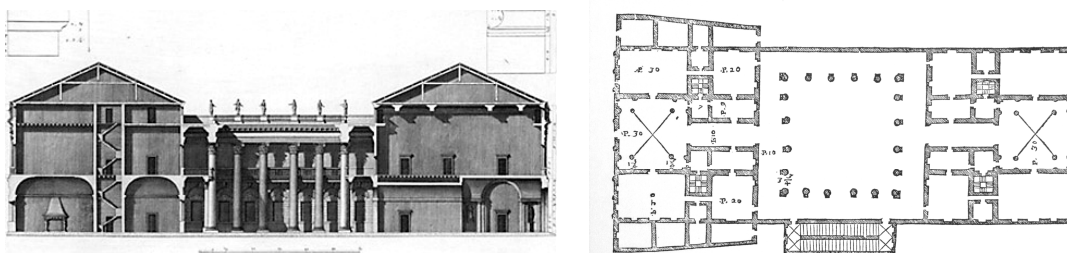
Palazzo Iseppo Porto de Palladio em Vicenza, Secção e Planta. (Scamozzi, 1776; Palladio, 1570)
